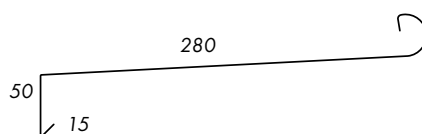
QUICK STEP - SolarThermie opbouw
